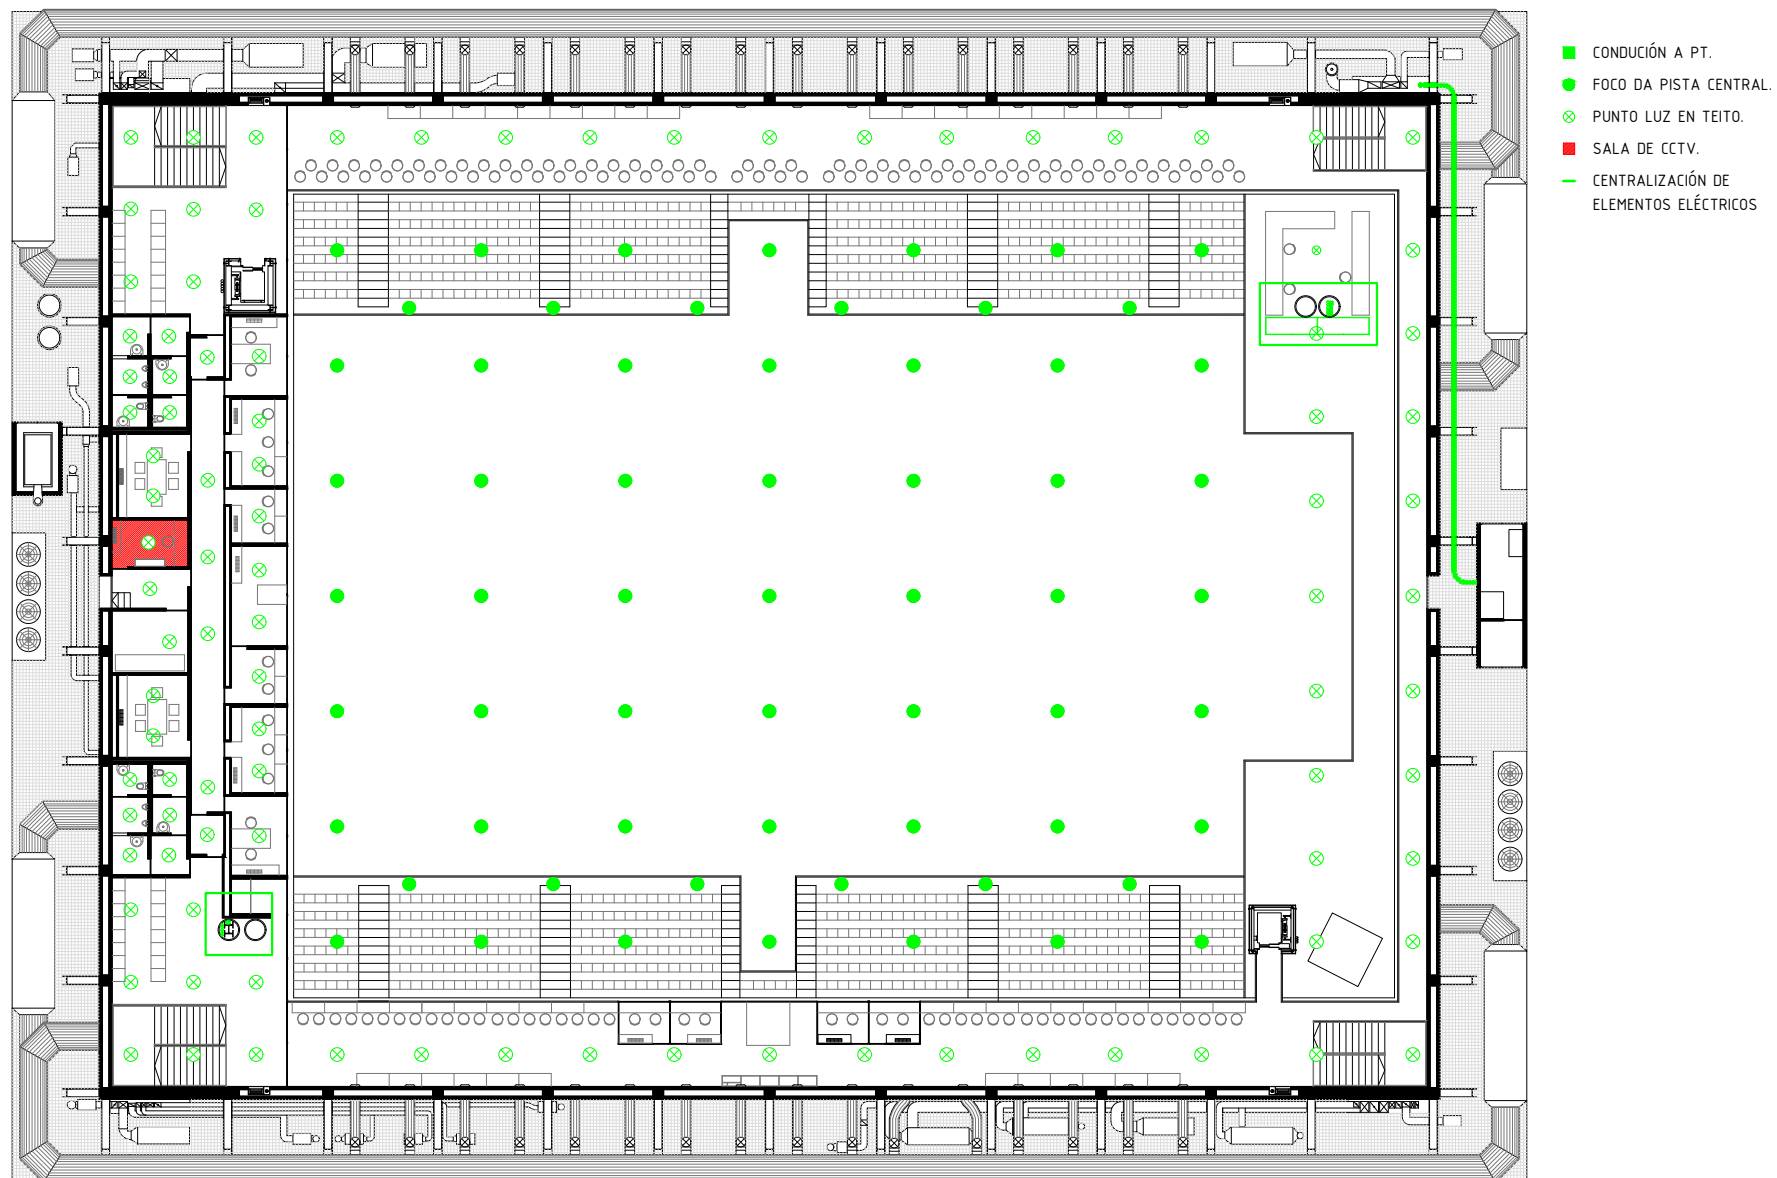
Instalación eléctrica na planta primeira. Escala 1/350.
